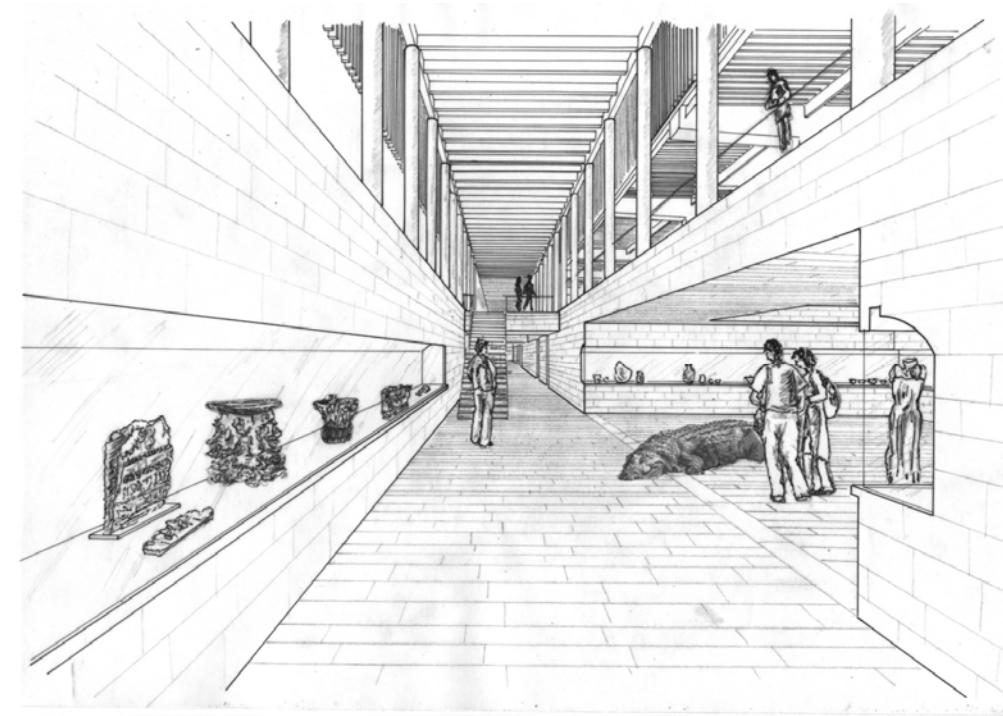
Zona espositiva al di sotto il pergolato derivato dalla interpretazione del progetto di Piranesi. Vista prospettica.
